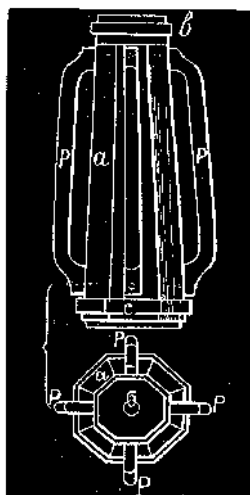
Ручная баба восьмиугольная поперечнаго сѣченія: а—баба, б—болтъ, с—чугунный поддонъ, с—бугель, р—ручки.
